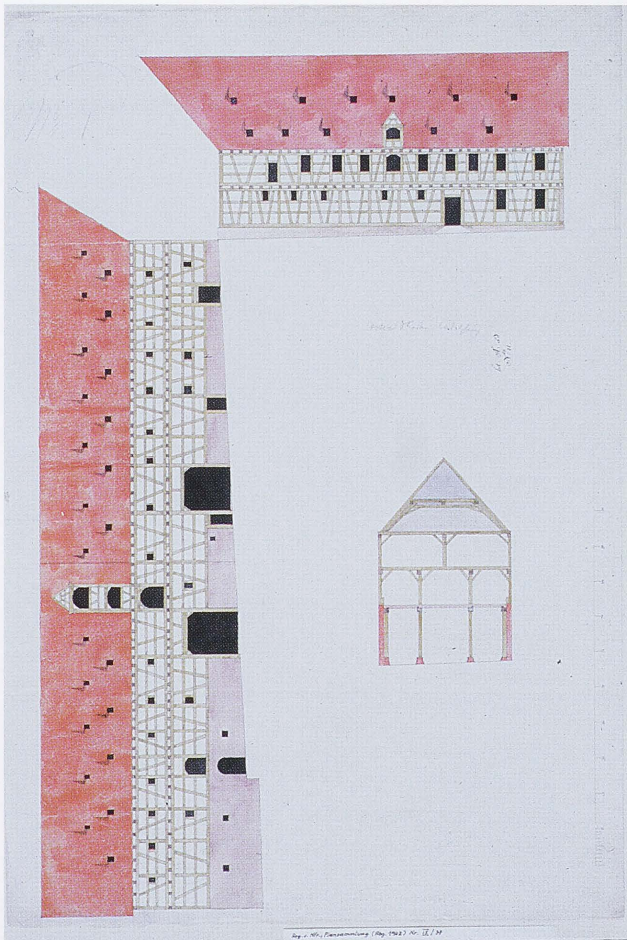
Abb. XI (oben links und rechts) Der große Getreidekasten, Plansatz Ende 18. Jahrhundert mit Ansicht vom Hof und Grundriß.
